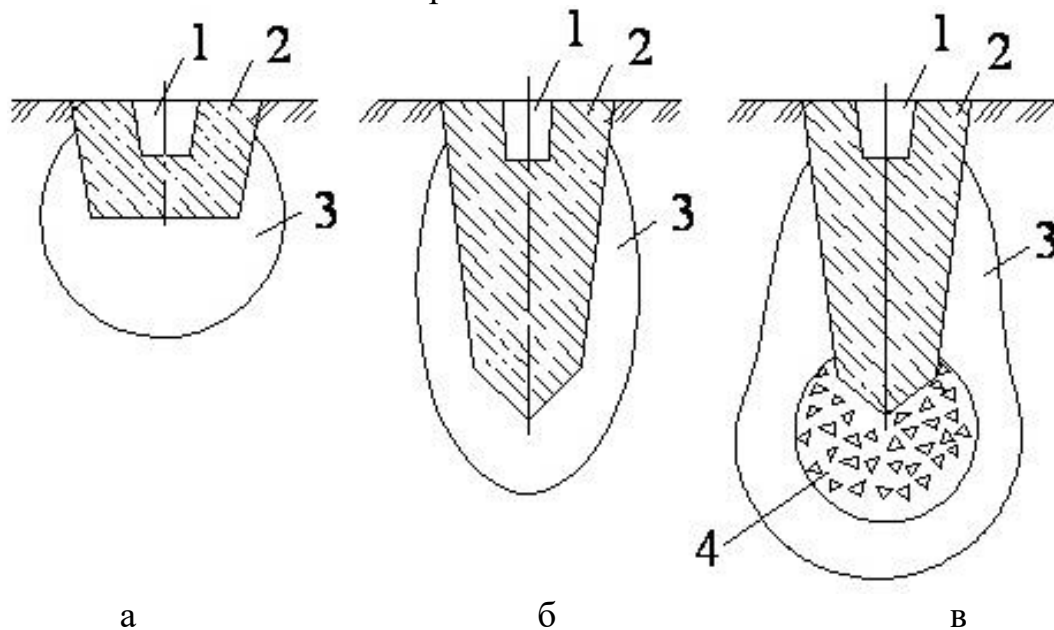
Схеми влаштування методом витрамбування котлованів фундаментів:
